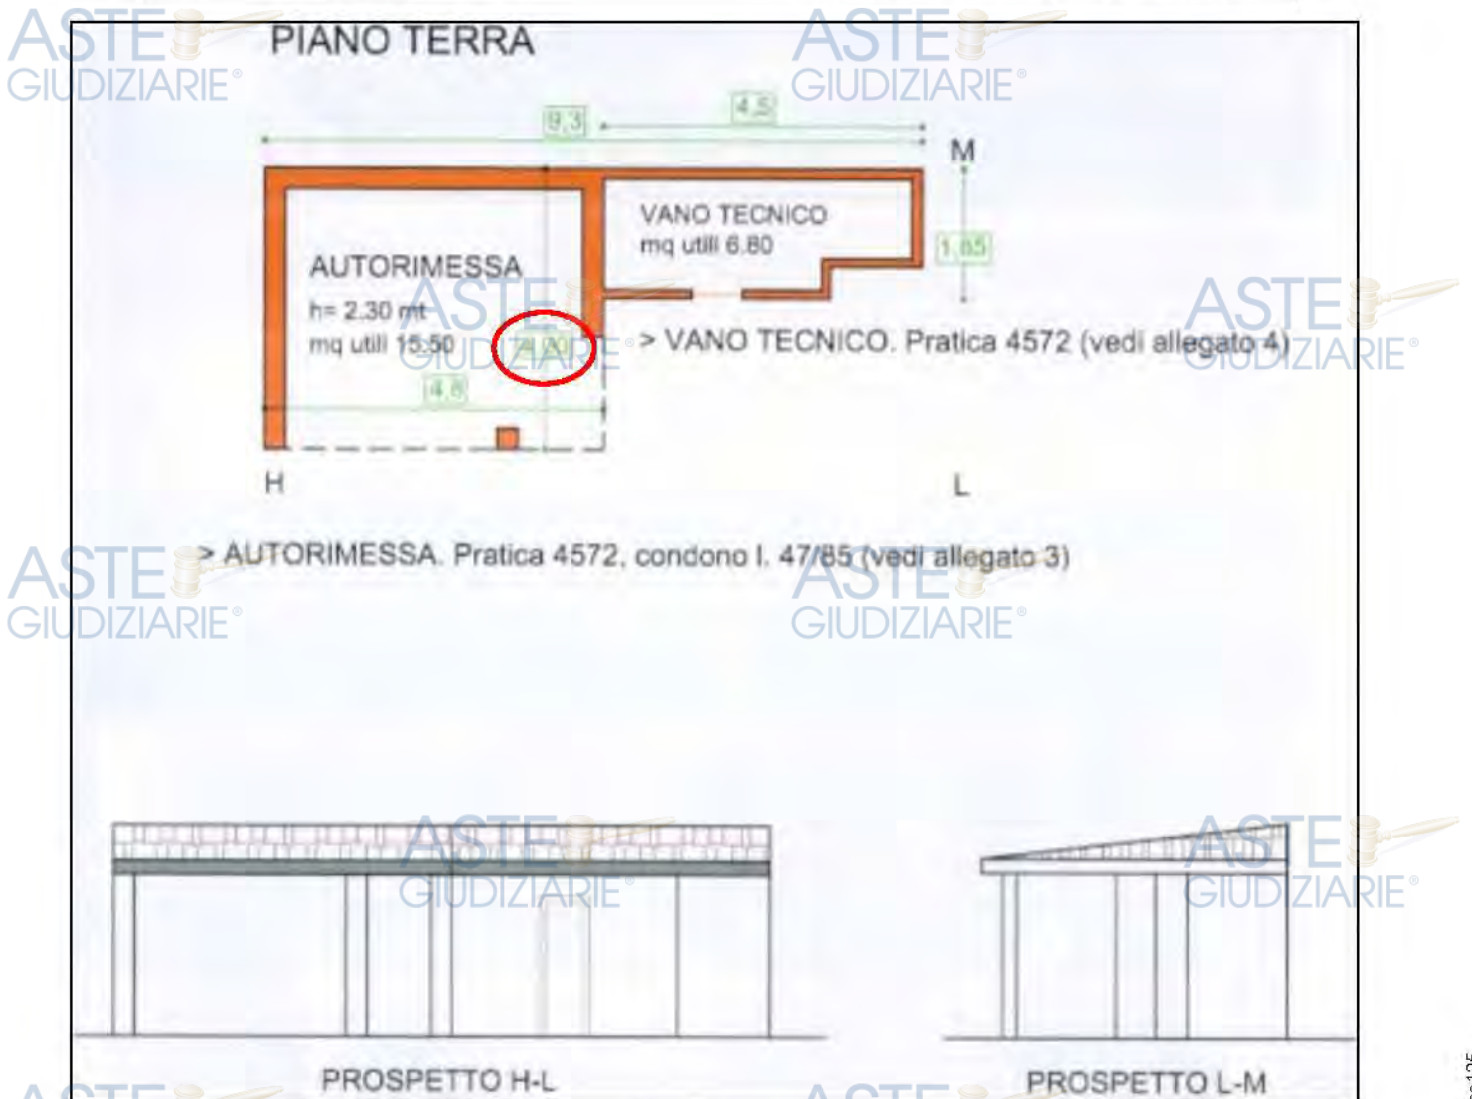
Subalterni 3 e 4 – Piano Terra – Planimetria stato di progetto. Concessione in Sanatoria n. 4572
